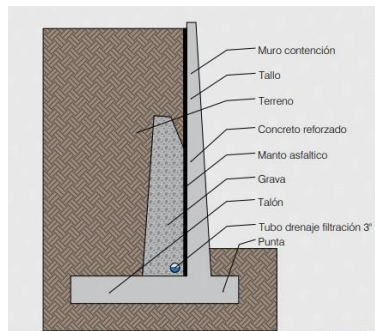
Detalle muro de contención – Fuente: Elaboración propia
